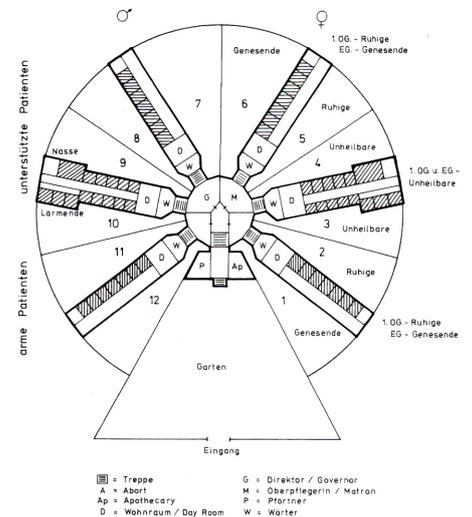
Grundriss Cornwall County Lunatic Asylum in Bodmin
